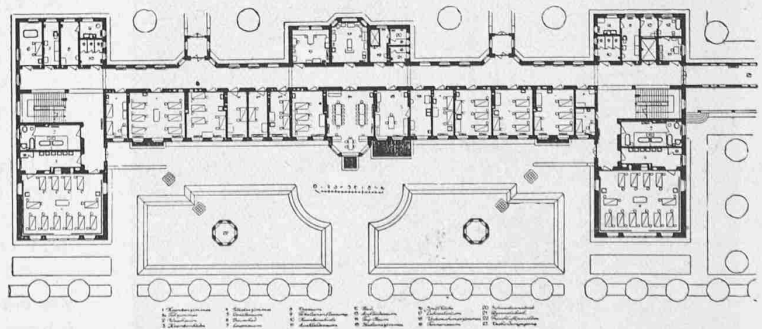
Krankenpavillon in Schwabing. — Erdgeschoss 1:1000.
